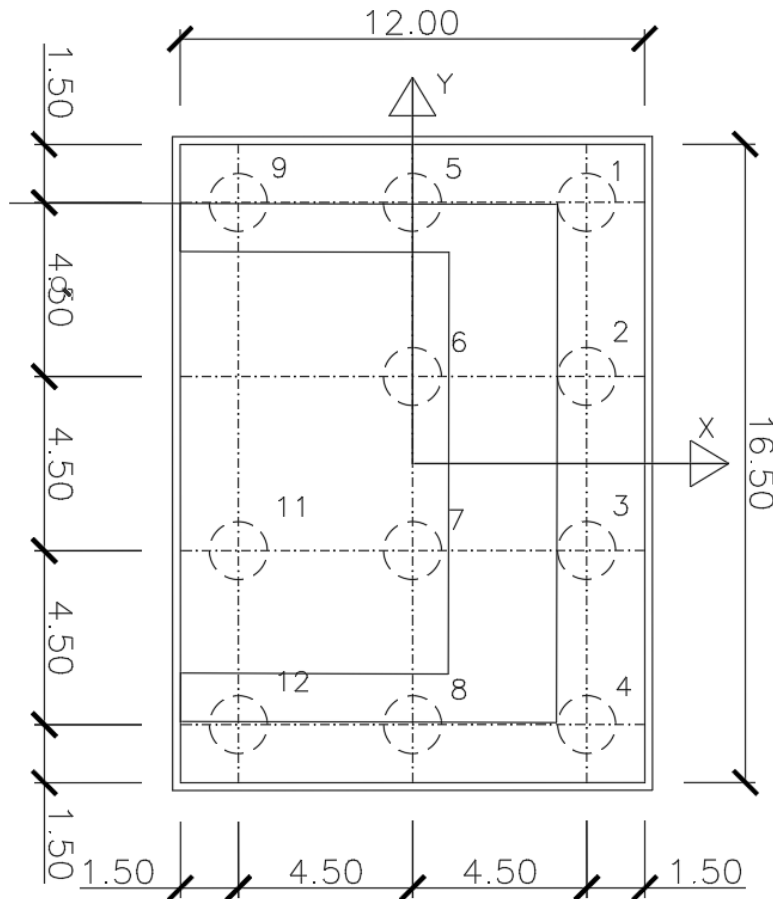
palificata a 11 pali spalla B come eseguita (schema con numerazione di calcolo)
